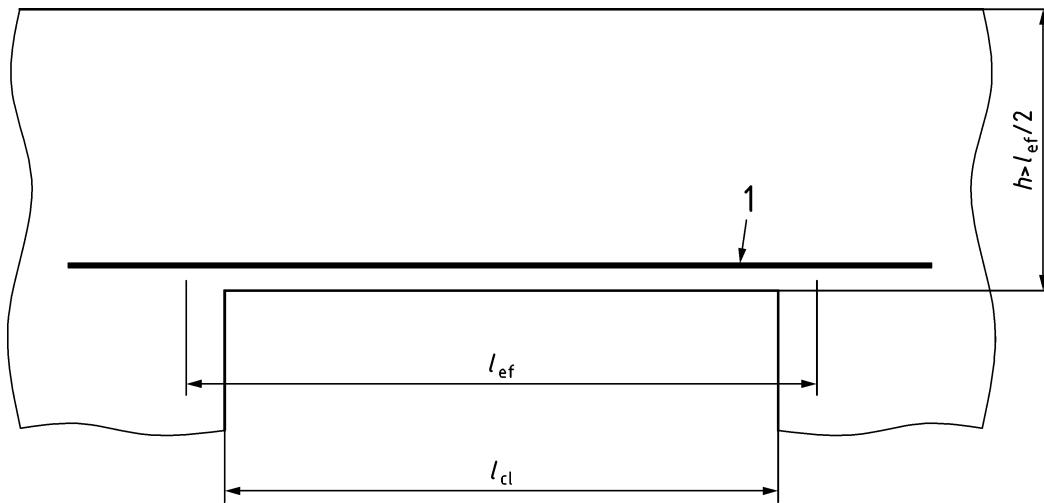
Stützweite von Mauerwerkkonsolen7.5.3.3 Hohe bewehrte Mauerwerk balken, die vertikaler Belastung ausgesetzt sind
